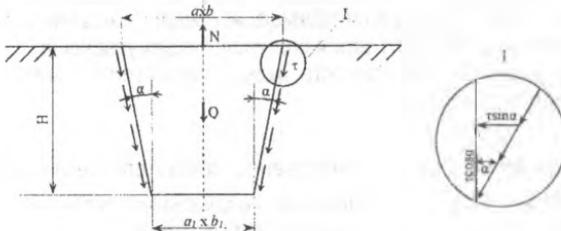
Расчётная схема для определения требуемого усилия извлечения трамбовки из грунта со схемой раскладки сил.
